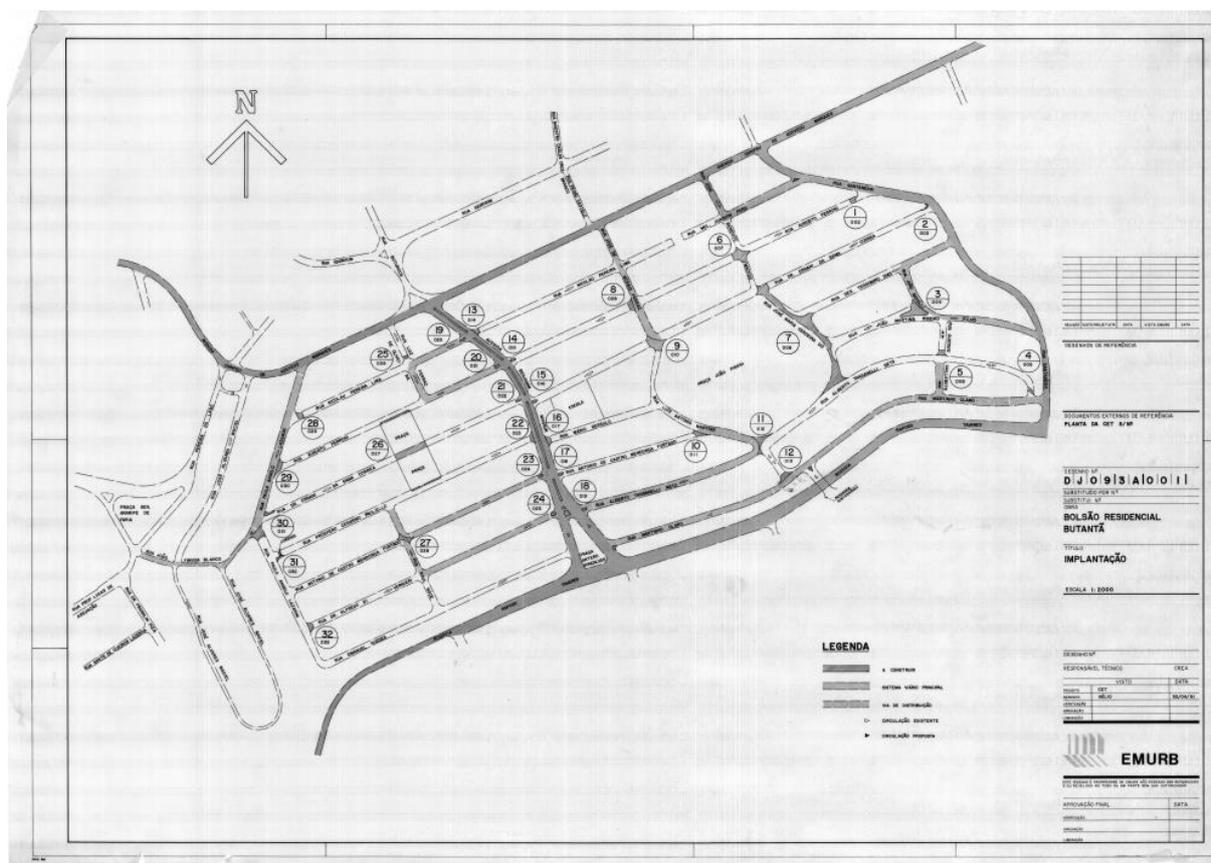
Implantação do projeto executivo do bolsão residencial Conjunto Residencial Butantã. Fonte: Acervo Emurb – digitalização de prancha técnica realizada pelo pesquisador.
